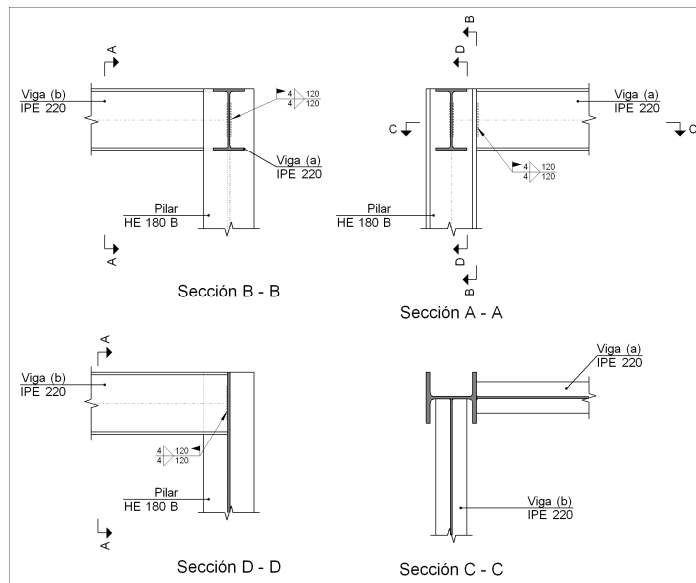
Detalle de las soldaduras tipo 2 del soporte superior
